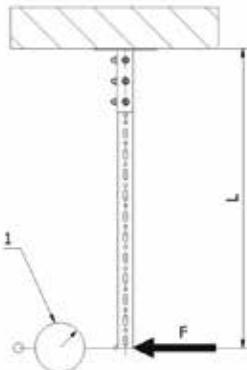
Configurazione di prova per staffa fissa a muro / Test set-up for a wall fixed cantilever bracket
